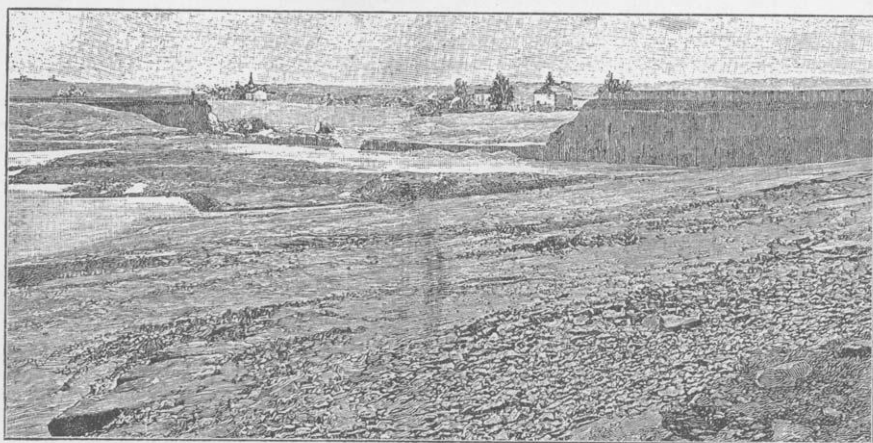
Sperrmauer von Bouzey. Wasserseitige Ansicht nach dem Bruche.
